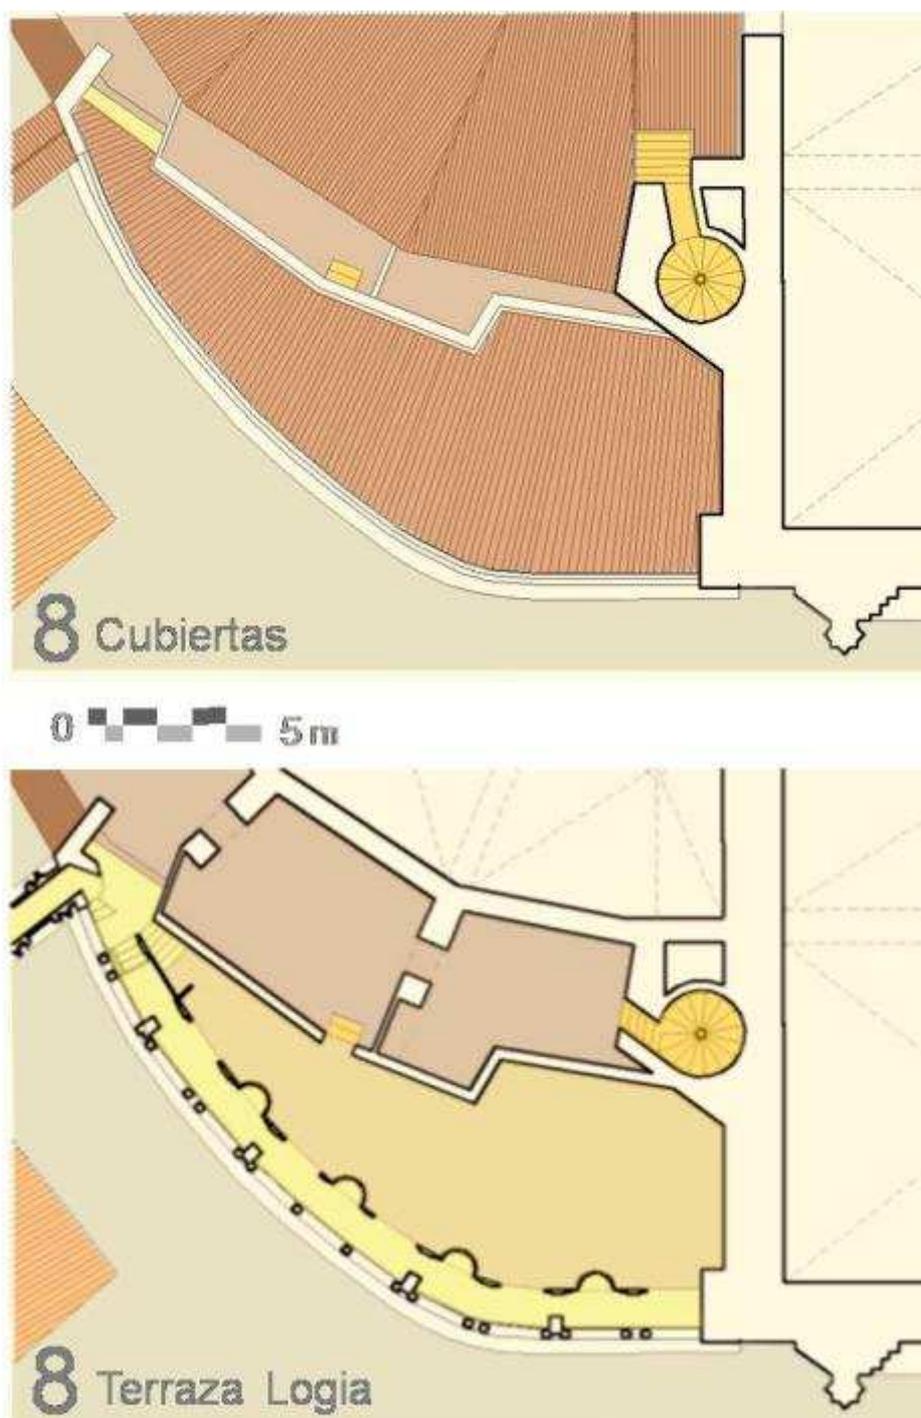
18.4 Hipótesis del autor. Alteraciones realizadas durante la renovación neoclásica. En el plano inferior, construcción de tabiquerías en lo que anteriormente era terraza en planta segunda, destinando su uso a escuela de gramática <sup>867</sup>. Tanto en esta planta como en la primera, puede apreciarse cómo al compartir el espacio se dejó solamente un pasillo recayendo a la plaza. En el plano superior, cubierta de teja sobre la girola.
